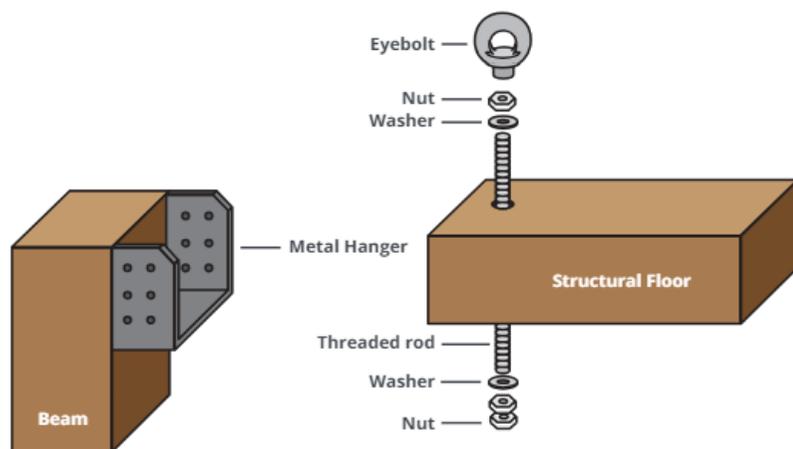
Tipo de anclaje del módulo 2D. Fuente: Azalea.
